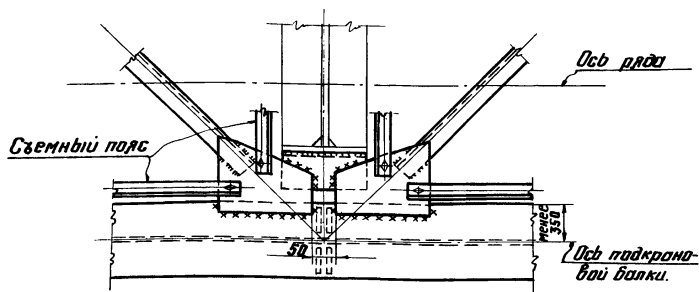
Крепление верхнего пояса разрезных подкрановых балок к столбным колоннам при наличии тормозных ферм
